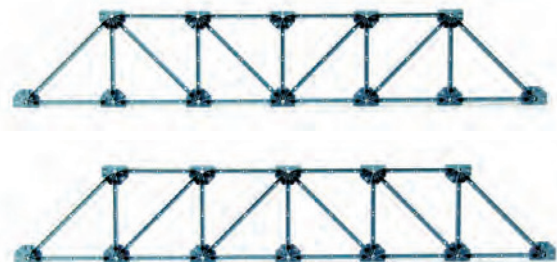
Pratt'sches Fachwerk (oben) und Howe'sches Fachwerk (unten).
